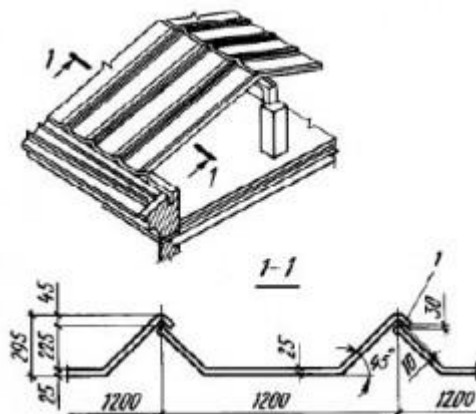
Сборная железобетонная скатная крыша из складчатых панелей трапецидального профиля: 1 — цементный раствор
